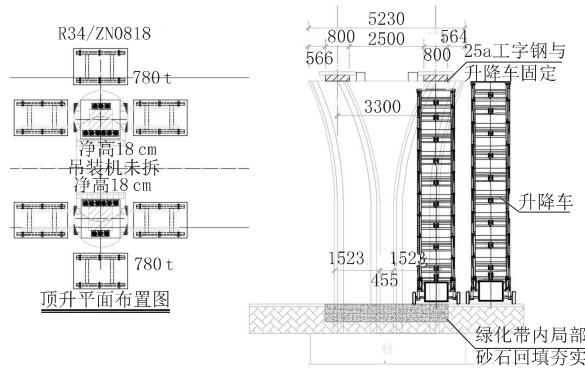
分离式道路墩柱液压升降车施工示意图(单位:mm)
